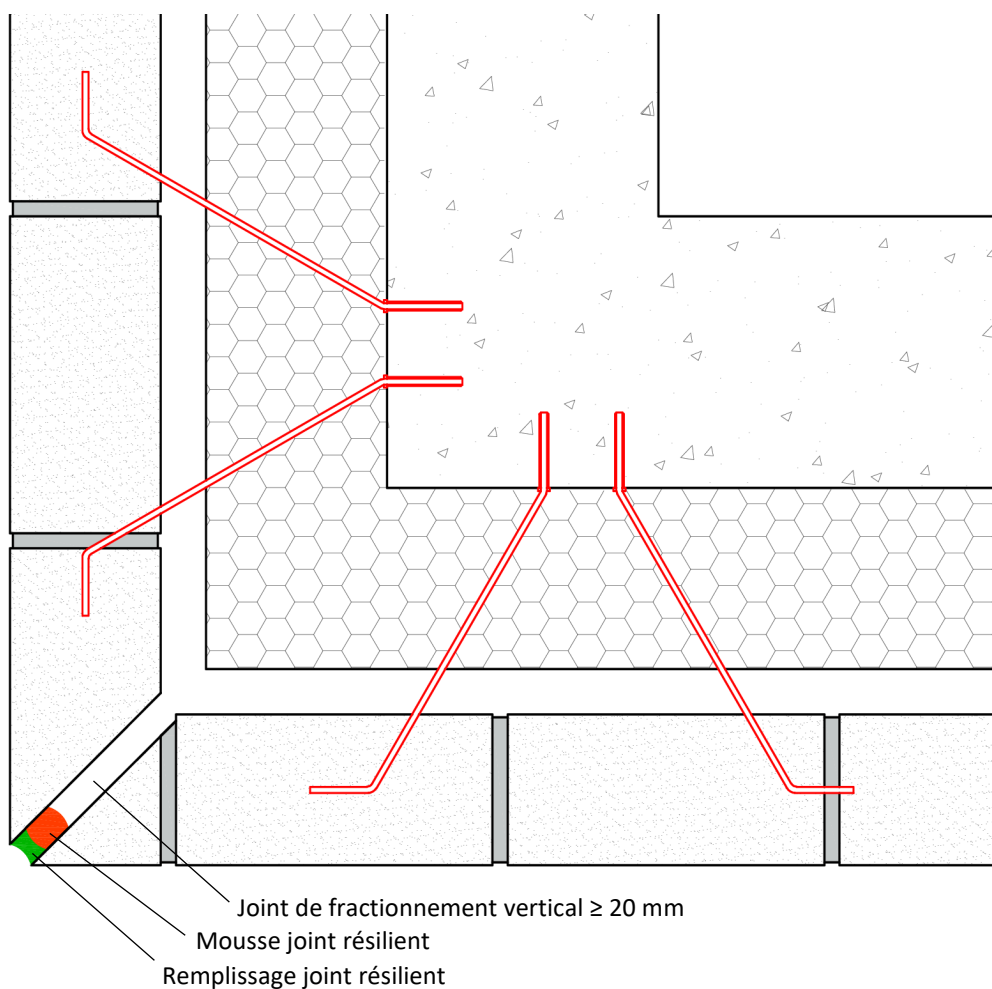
Joint de fractionnement vertical - coupe en bec d'onglet (coupe)
